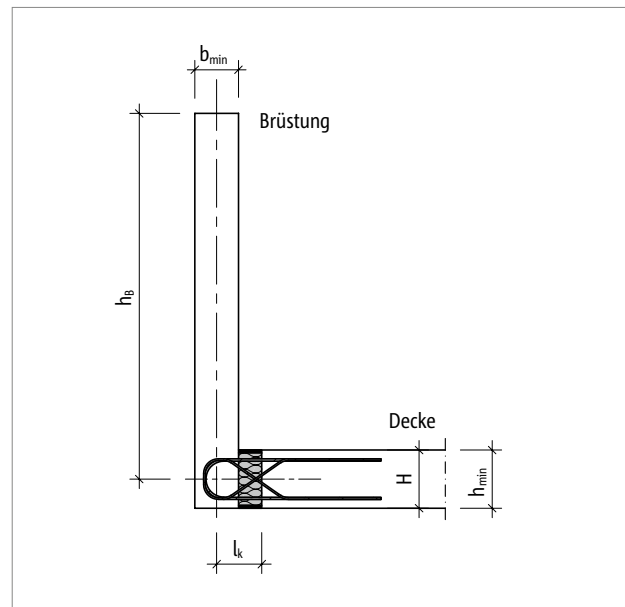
Schöck Isokorb® T Typ AP: Statisches System Brüstungshöhe  $h_B$ ; Isokorb® Höhe H
